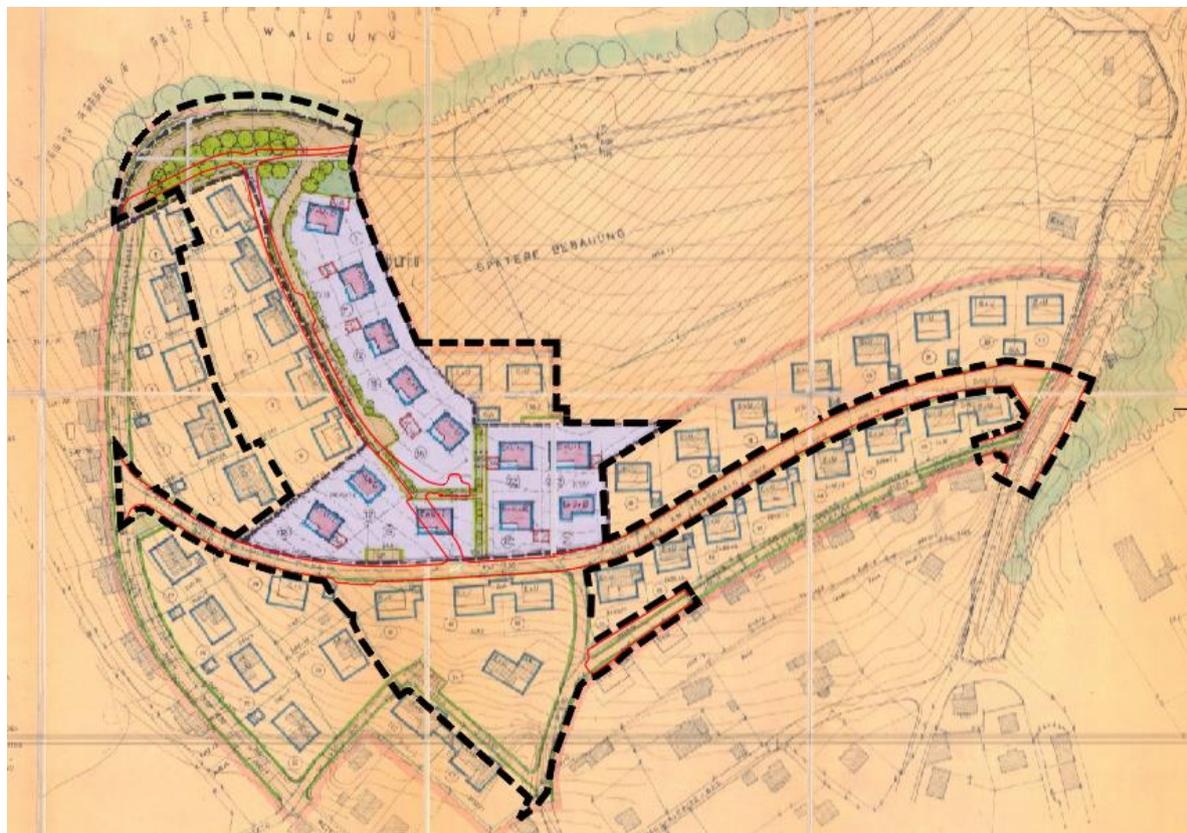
Vergleich der Erschließungsflächen AM 8A mit Änderung zu AM 129 (rote Linien)
